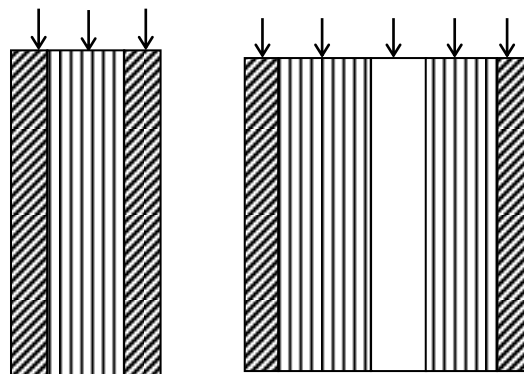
Coupe transversale d'un mur extérieur et intérieur
